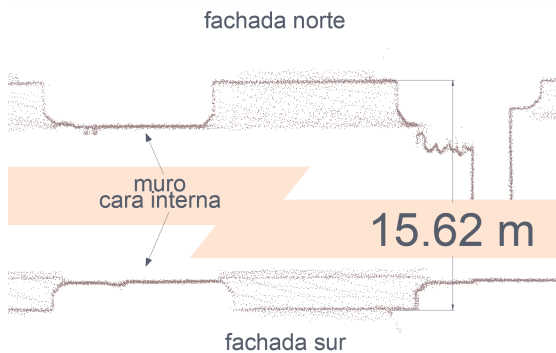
esquema del ancho máximo medido. En la imagen se distinguen una ventana y el alfeizar interior de las fachadas norte (arriba) y sur (abajo).
